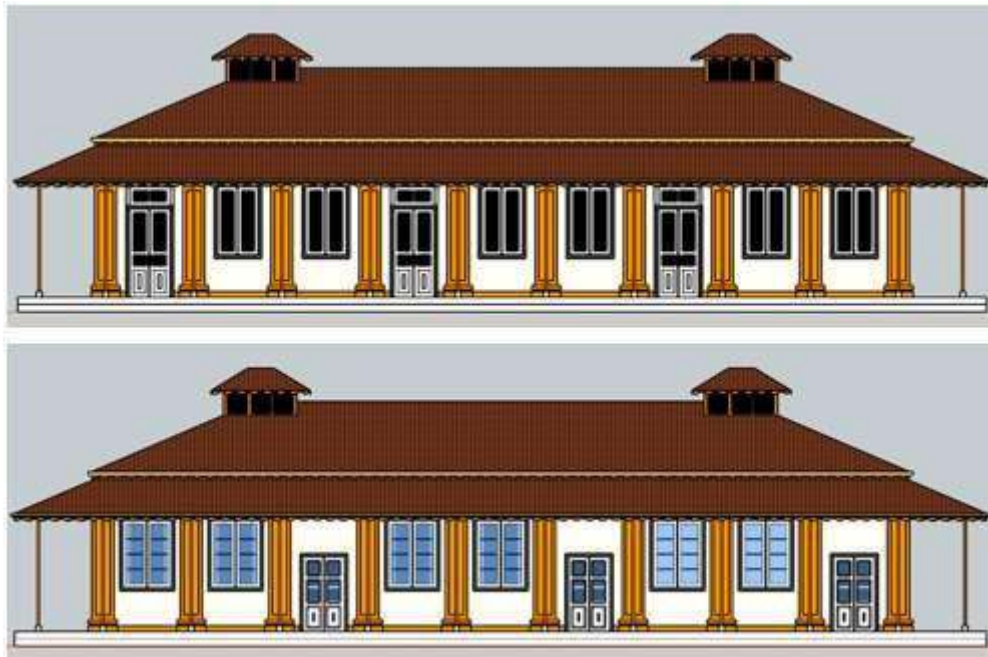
Fasade bangunan utamai SMPN 14 Cirebon
